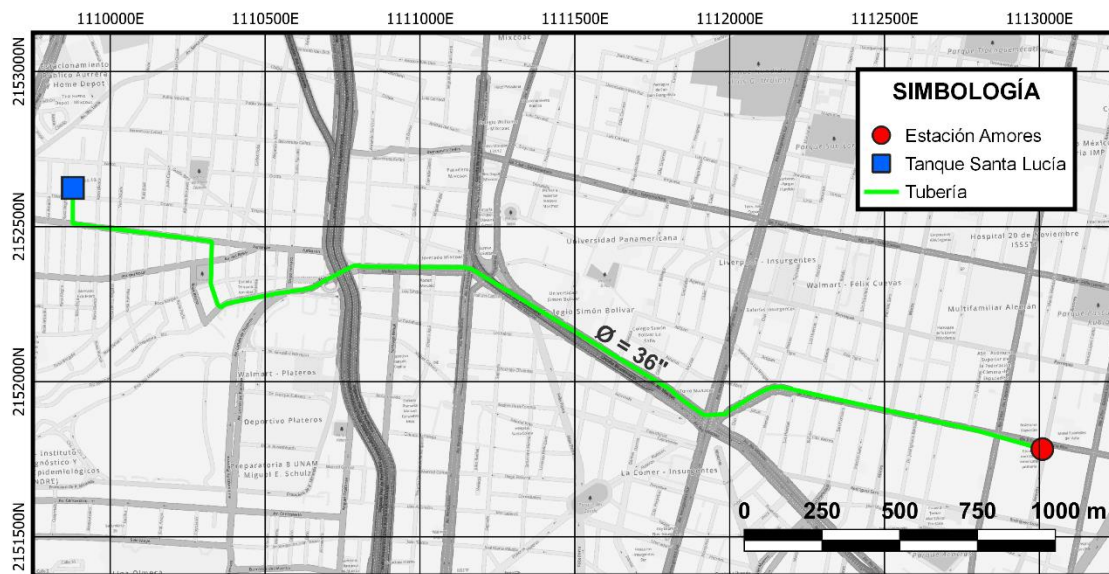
Planta de la tubería del tanque Santa Lucía a la estación Amores
